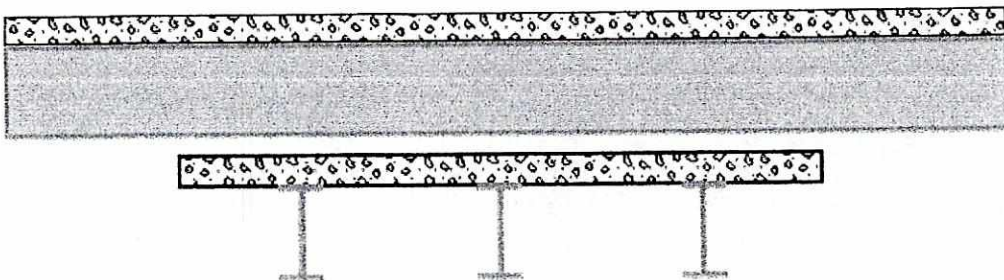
Puente con losa ortotrópica y vigas de metal
